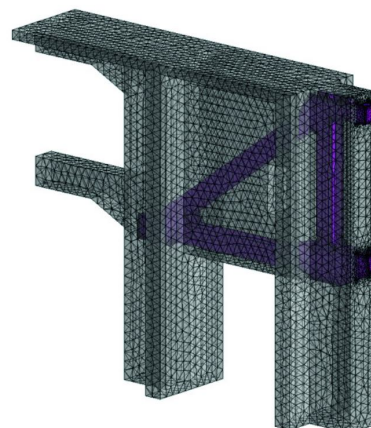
Конечно-элементная модель узла сопряжения в зоне опирания стальных ферм на монолитные конструкции
